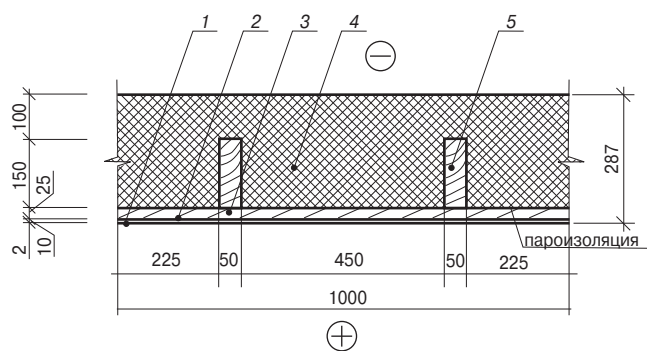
Схема чердачного покрытия: 1 – керамическое теплоизоляционное покрытие; 2 – гипсокартон; 3 – подшивная доска; 4 – плитный утеплитель; 5 – деревянная балка покрытия
